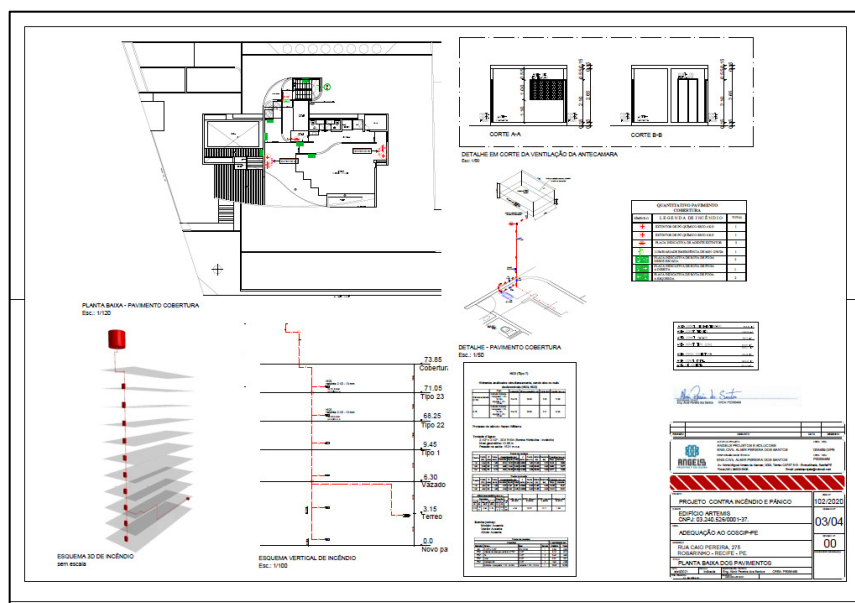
AutoCad – Projeto de combate a incêndio (planta baixa, isometria, informativos)
